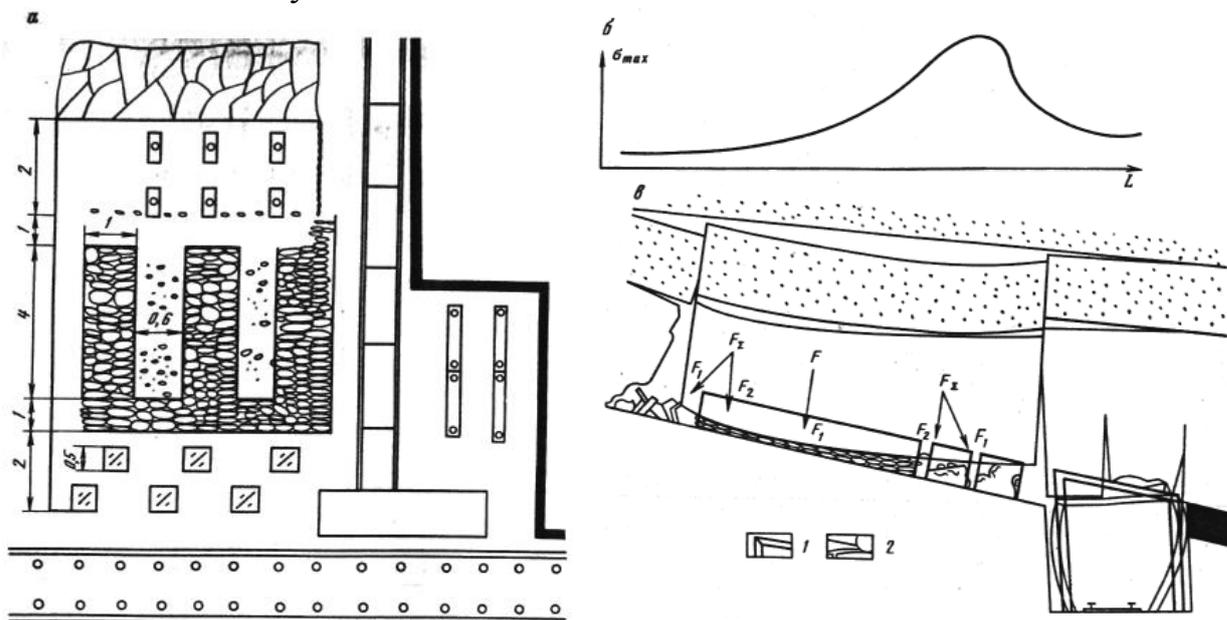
Паспорт управления кровлей по схеме 1 (а), эпюра (б) и схеме (в) напряженного состояния массива горных пород кровли: 1, 2 – положение кровли и охранной крепи соответственно до и после осадки горных пород
